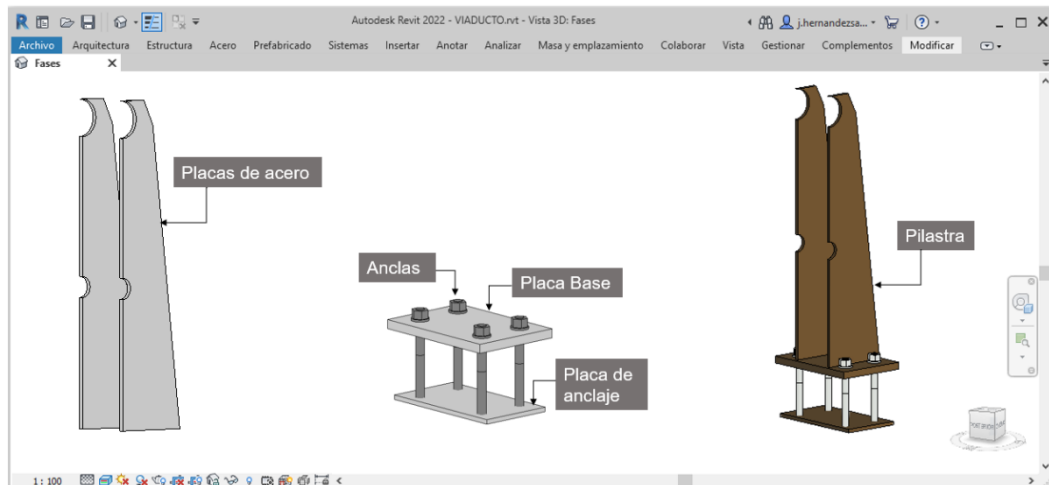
Modelado de pilastras del Parapeto. Fuente: Elaboración propia
